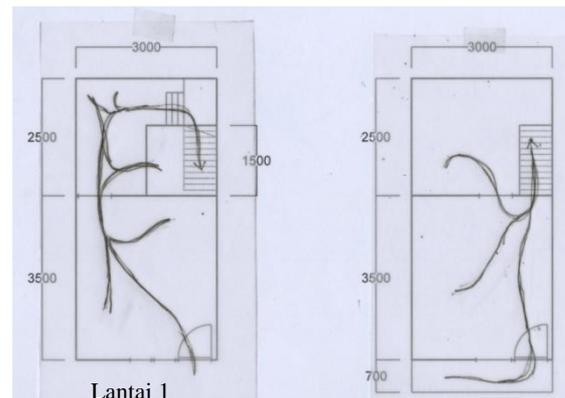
Denah lantai 1 rumah mbak Sr
